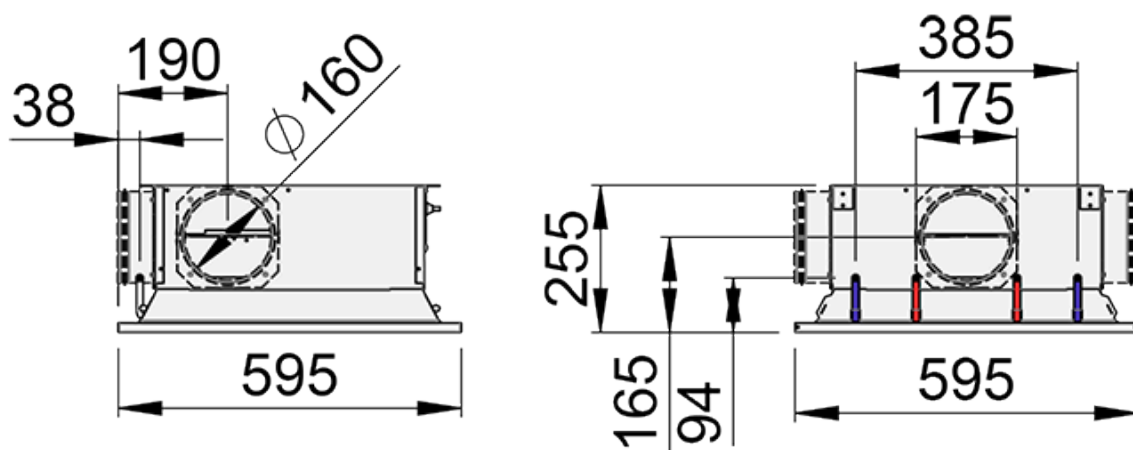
Halton Rex RXP, dimensioner för flexible model (RXP/F-600)
